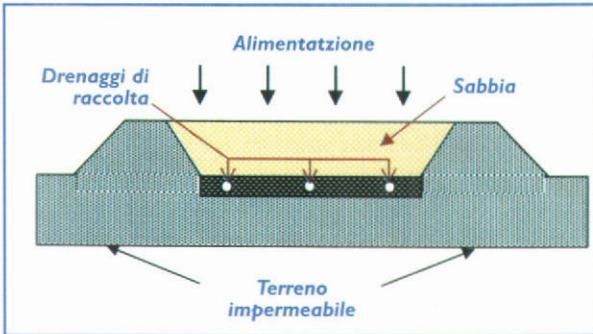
Sistema di drenaggio su terreno impermeabile (Agences de l'Eau, 1993)
